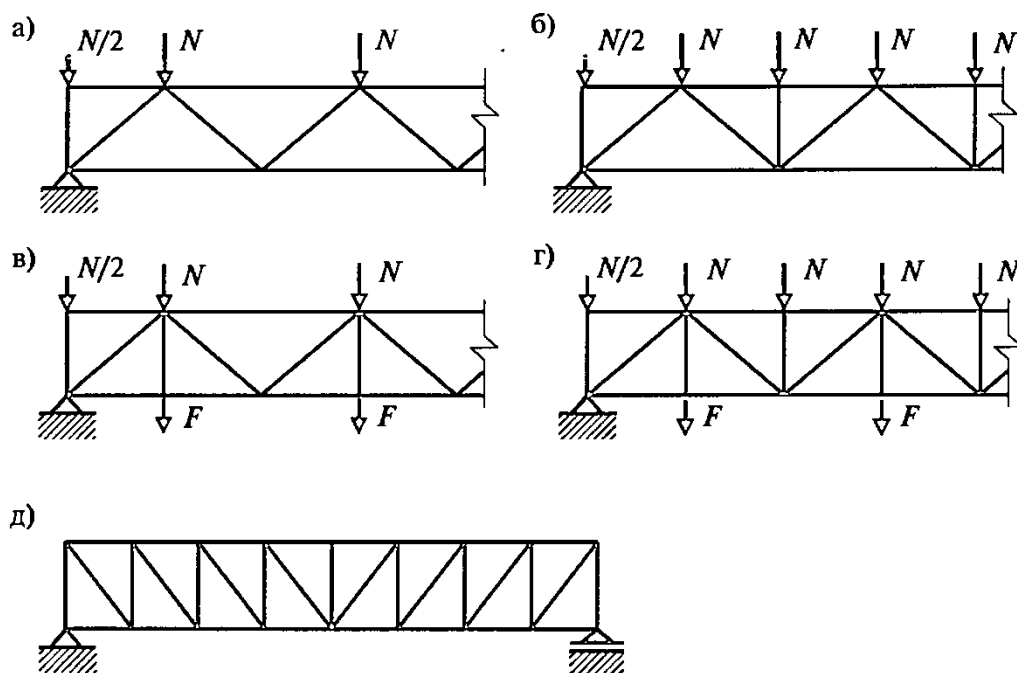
Системы решеток: а) треугольная; б) треугольная со стойками; в) треугольная с подвесками; г) треугольная со стойками и подвесками; д) раскосная система с нисходящими раскосами
